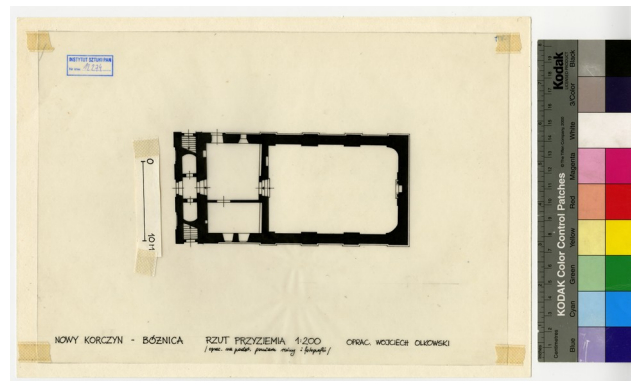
Grundriss Erdgeschoss 1987
